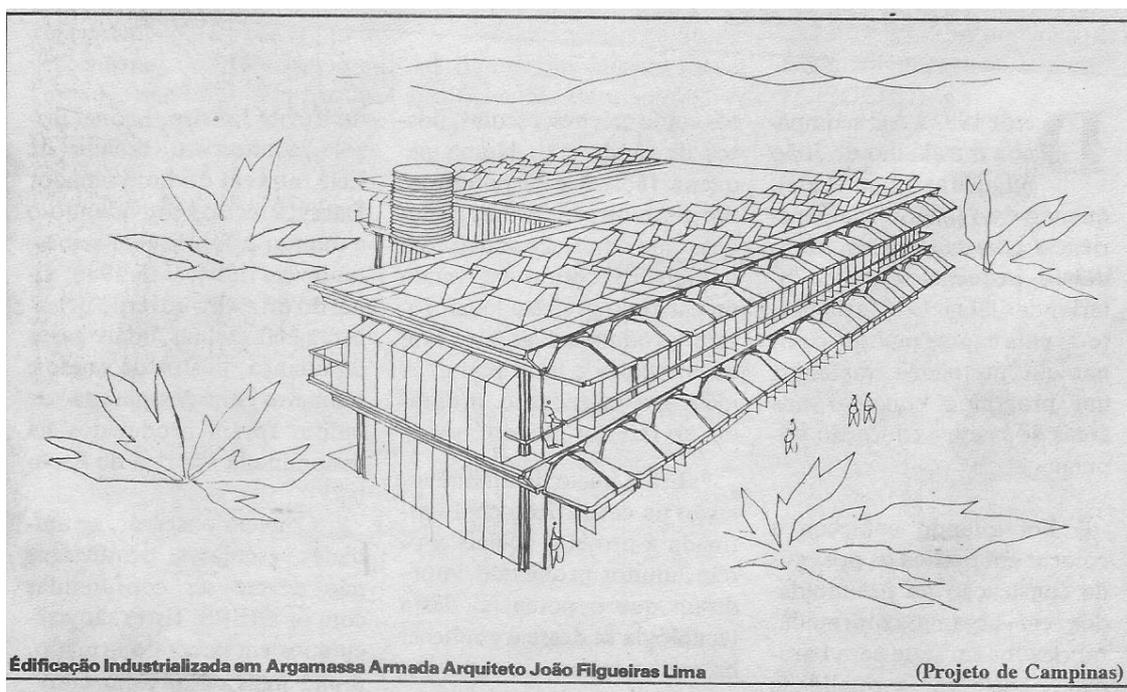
Perspectiva superior do projeto para FAC Campinas, em argamassa armada com opção para dois pavimentos. Fonte: ACA, 1991, p. 5.
